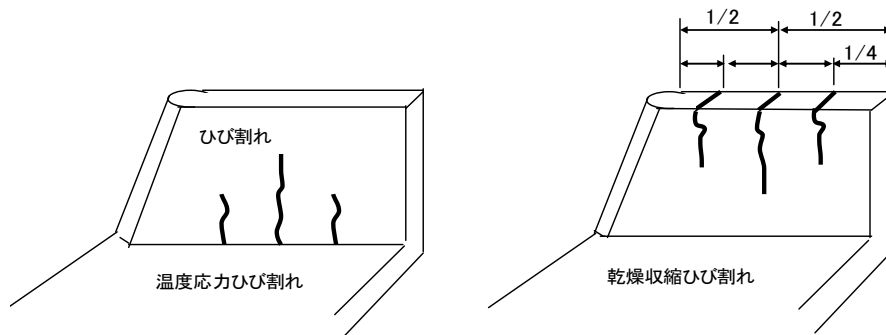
2. 14 乾燥収縮・温度応力ひび割れ発生位置（堰柱等）
